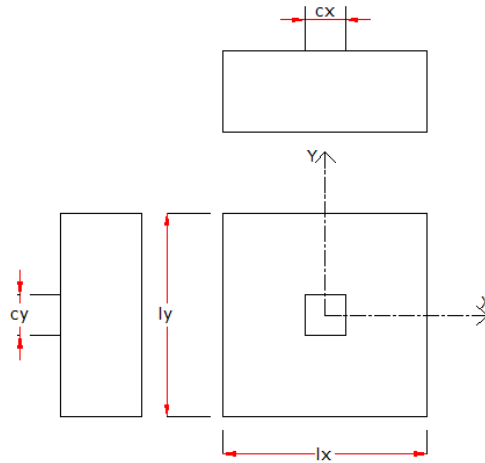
Zapata de espesor constante. Fuente: elaboración propia.
